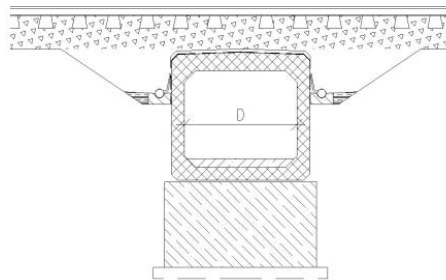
Exemplu de podet realizat din cadre prefabricate din beton armat
